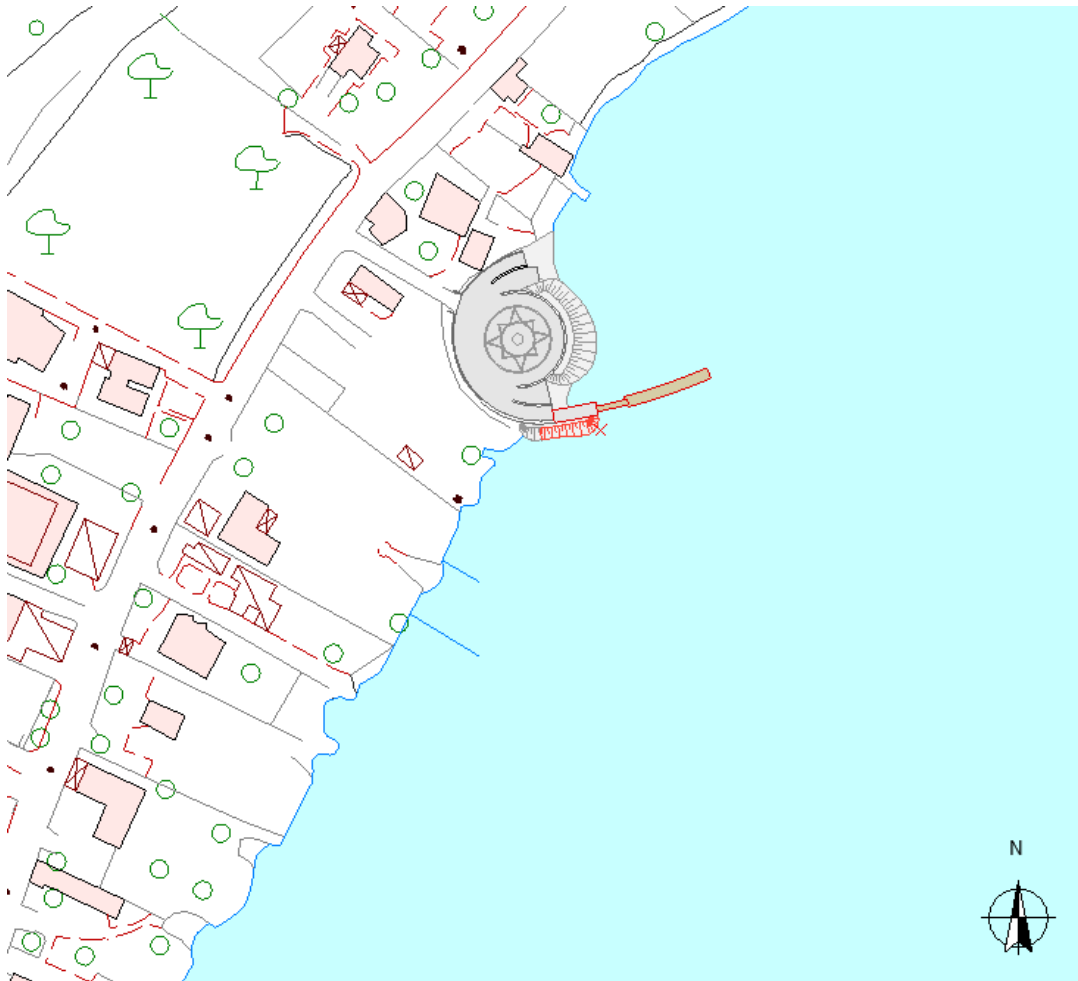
Planimetria con inserimento del progetto su C.T.R.
